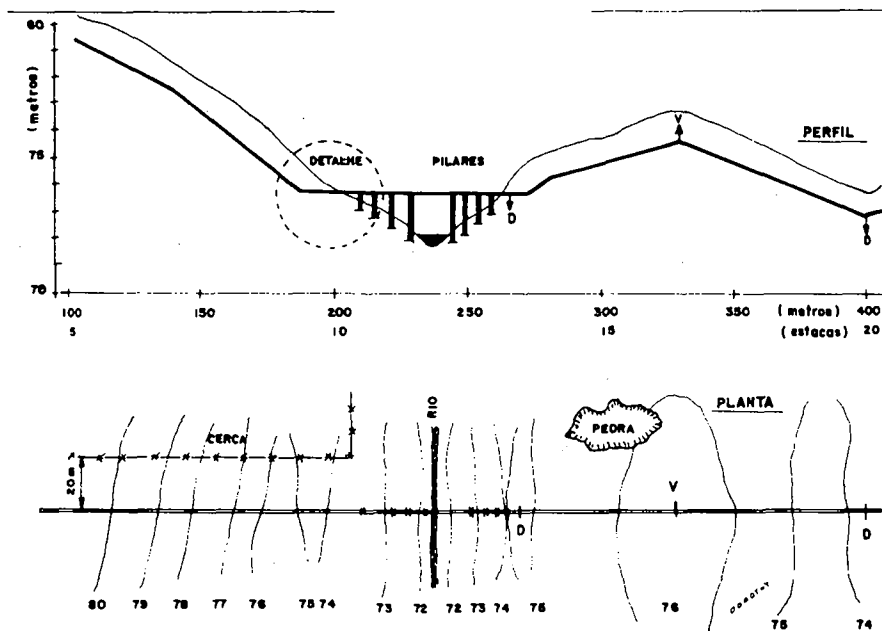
PLANTA E PERFIL DE TRECHO DE ADUTORA
